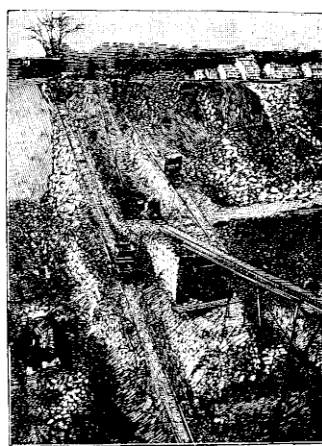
Carrière des Maréchaux. — Carrière du Pont Vert. — Plan incliné à 45° pour travaux de Terrassement, montage du pavé et débard des formes.
